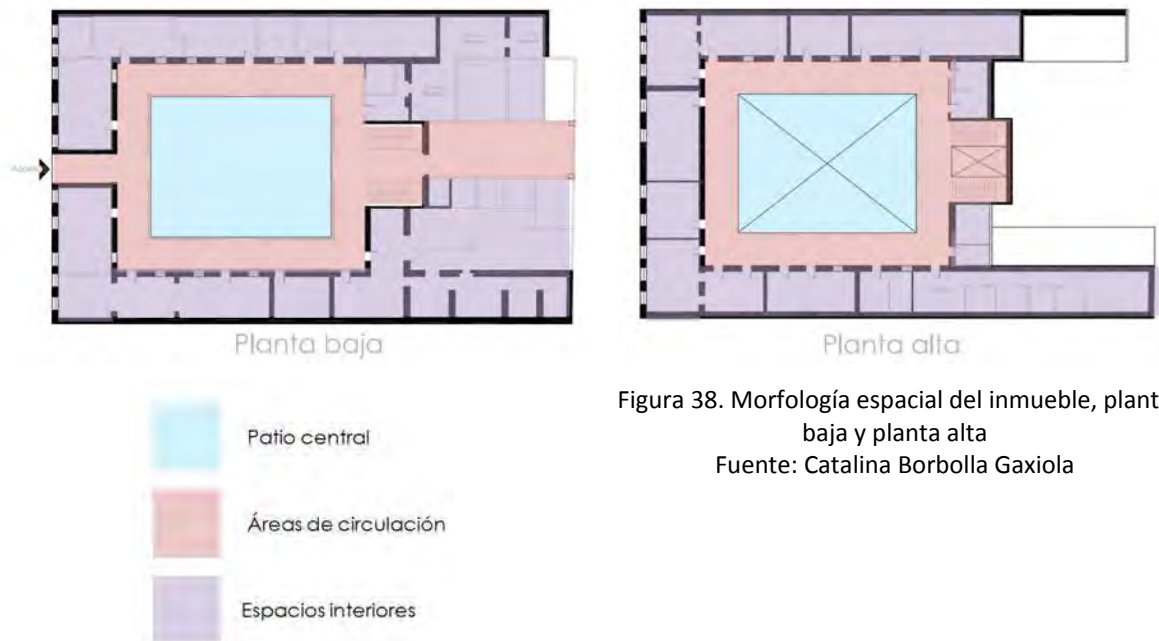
Morfología espacial del inmueble, planta baja y planta alta
